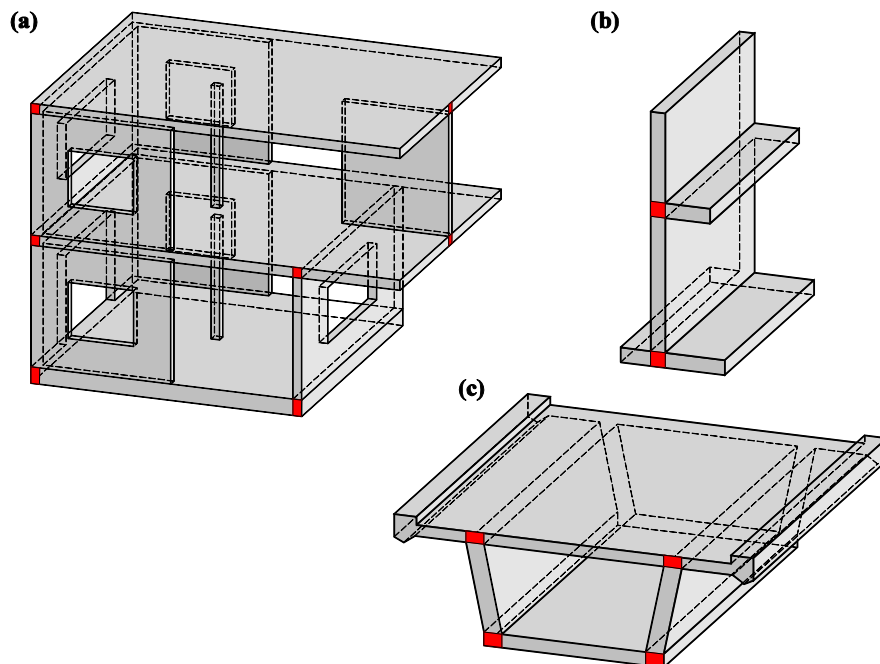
Beispiele von Rahmenecken (rot markiert) in Stahlbeton: (a) Typischer Hochbau; (b) Stützmauer; (c) Brückenträger.
